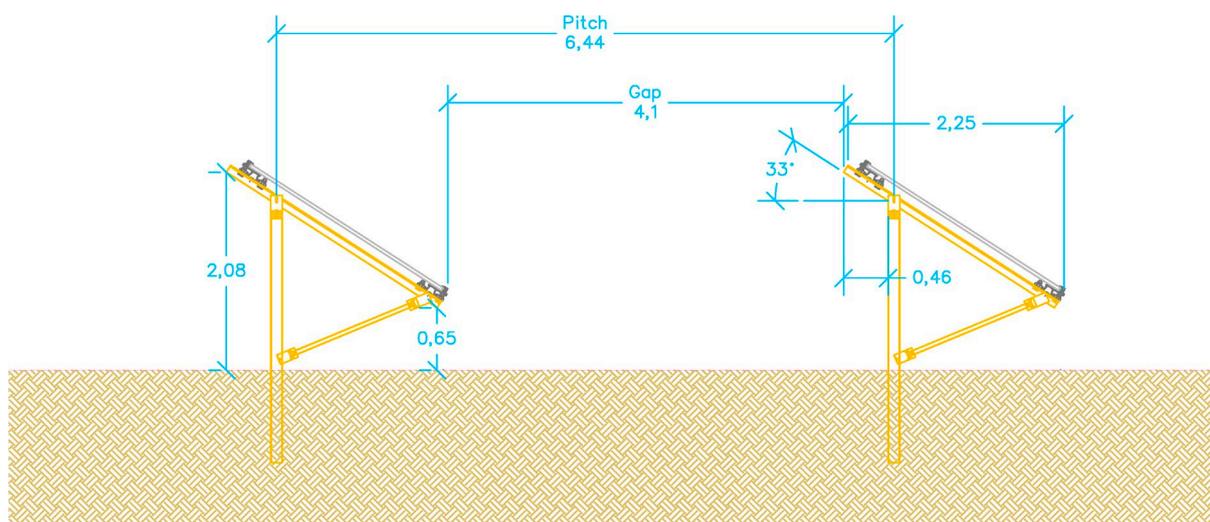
Vista dei tracker in sezione con particolare del passaggio di un mezzo agricolo
